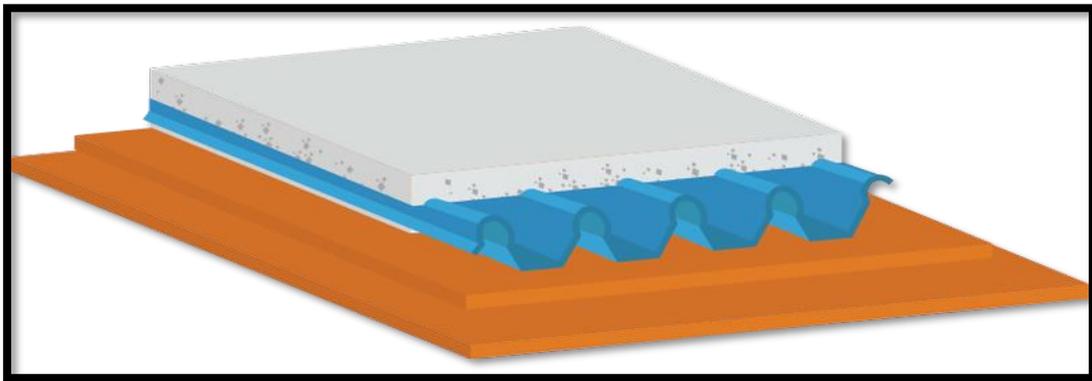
Dalle avec plafond coupe-feu<sup>203</sup>
